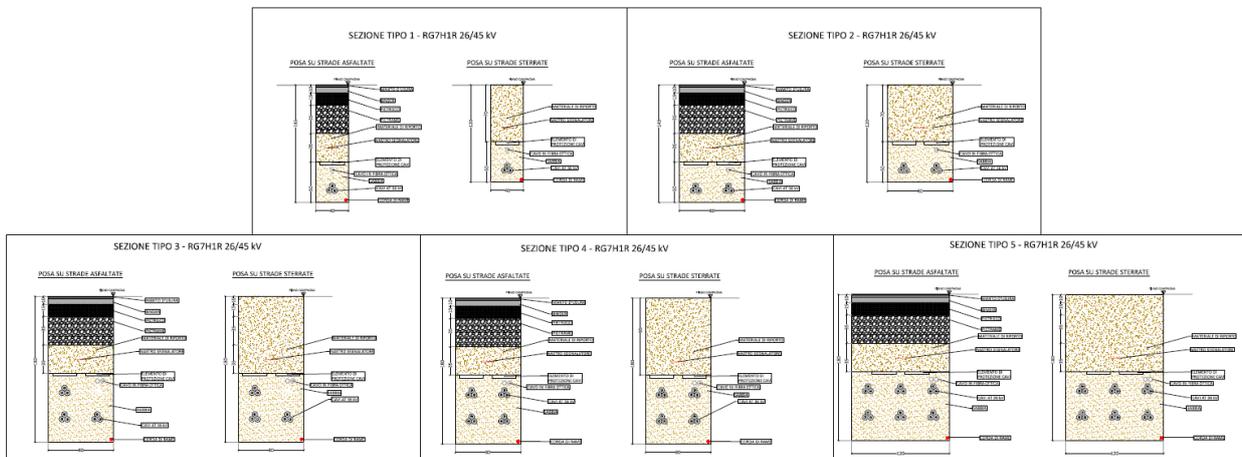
Sezioni di posa cavidotto AT 36 kV
